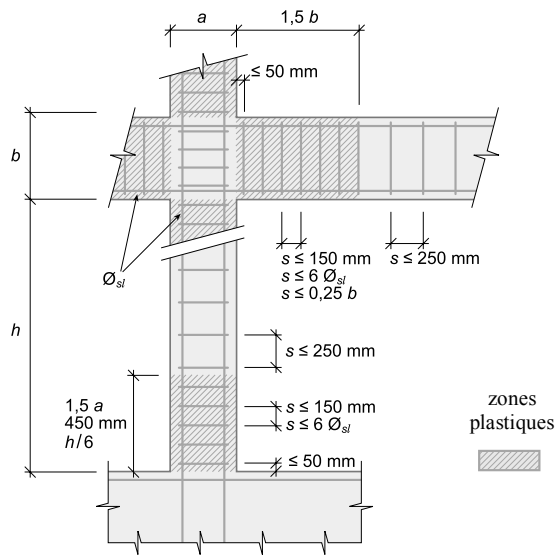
Dispositions constructives des poutres et des colonnes.
